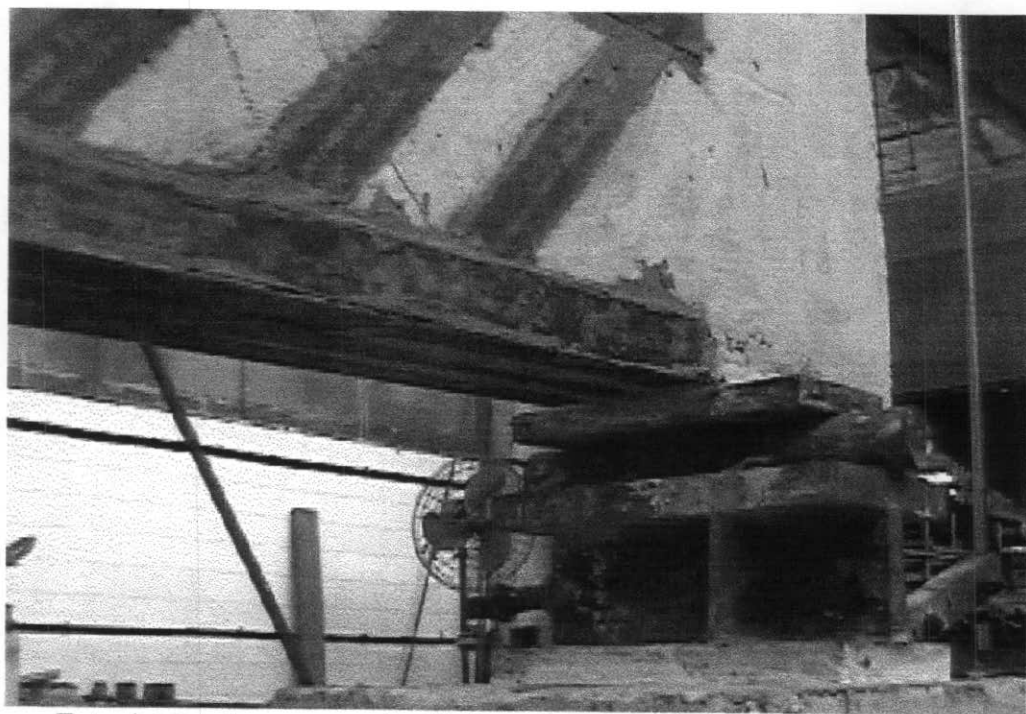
Ancoragem das lâminas de reforço à flexão da viga V5.
